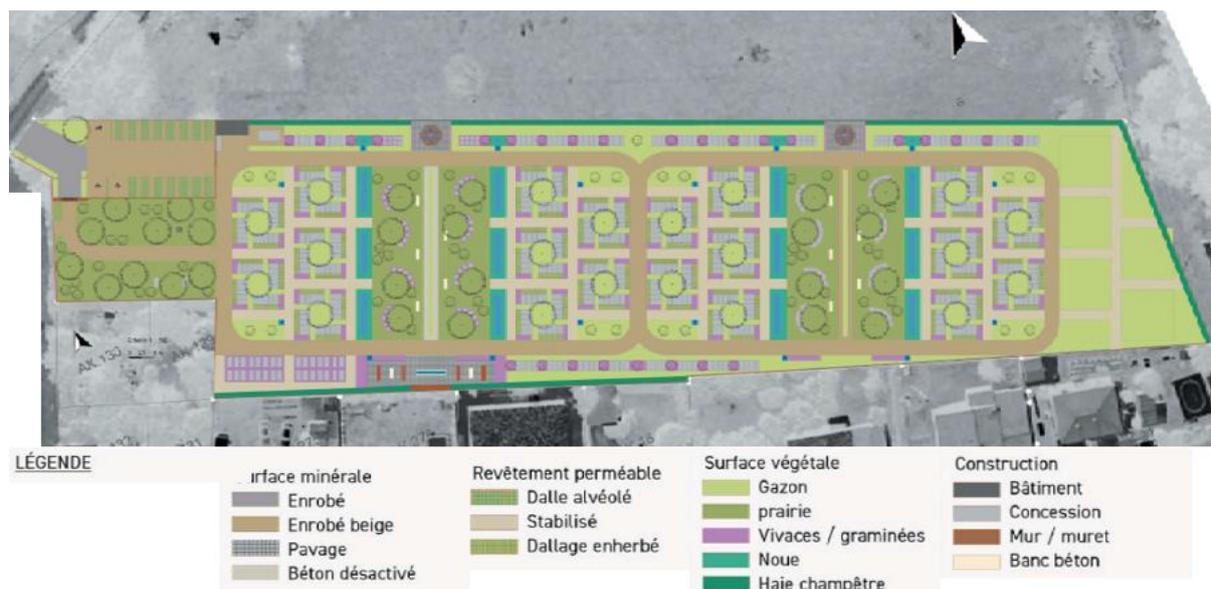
Plan d'aménagement de l'extension du cimetière (d'après le plan Iris, BE VRD et Gaëlle Combres, BE Paysage)
